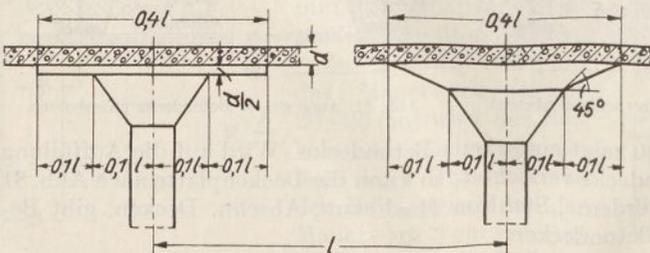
Skizze des Stützenkopfes einer Pilzdecke.
